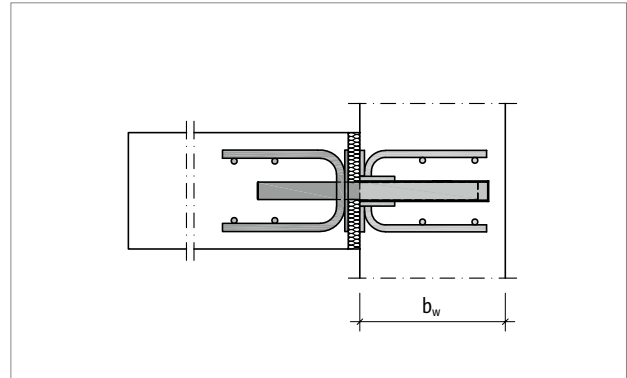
Stacon® SLD: Minimale Bauteildicke einer Wand oder Stütze
